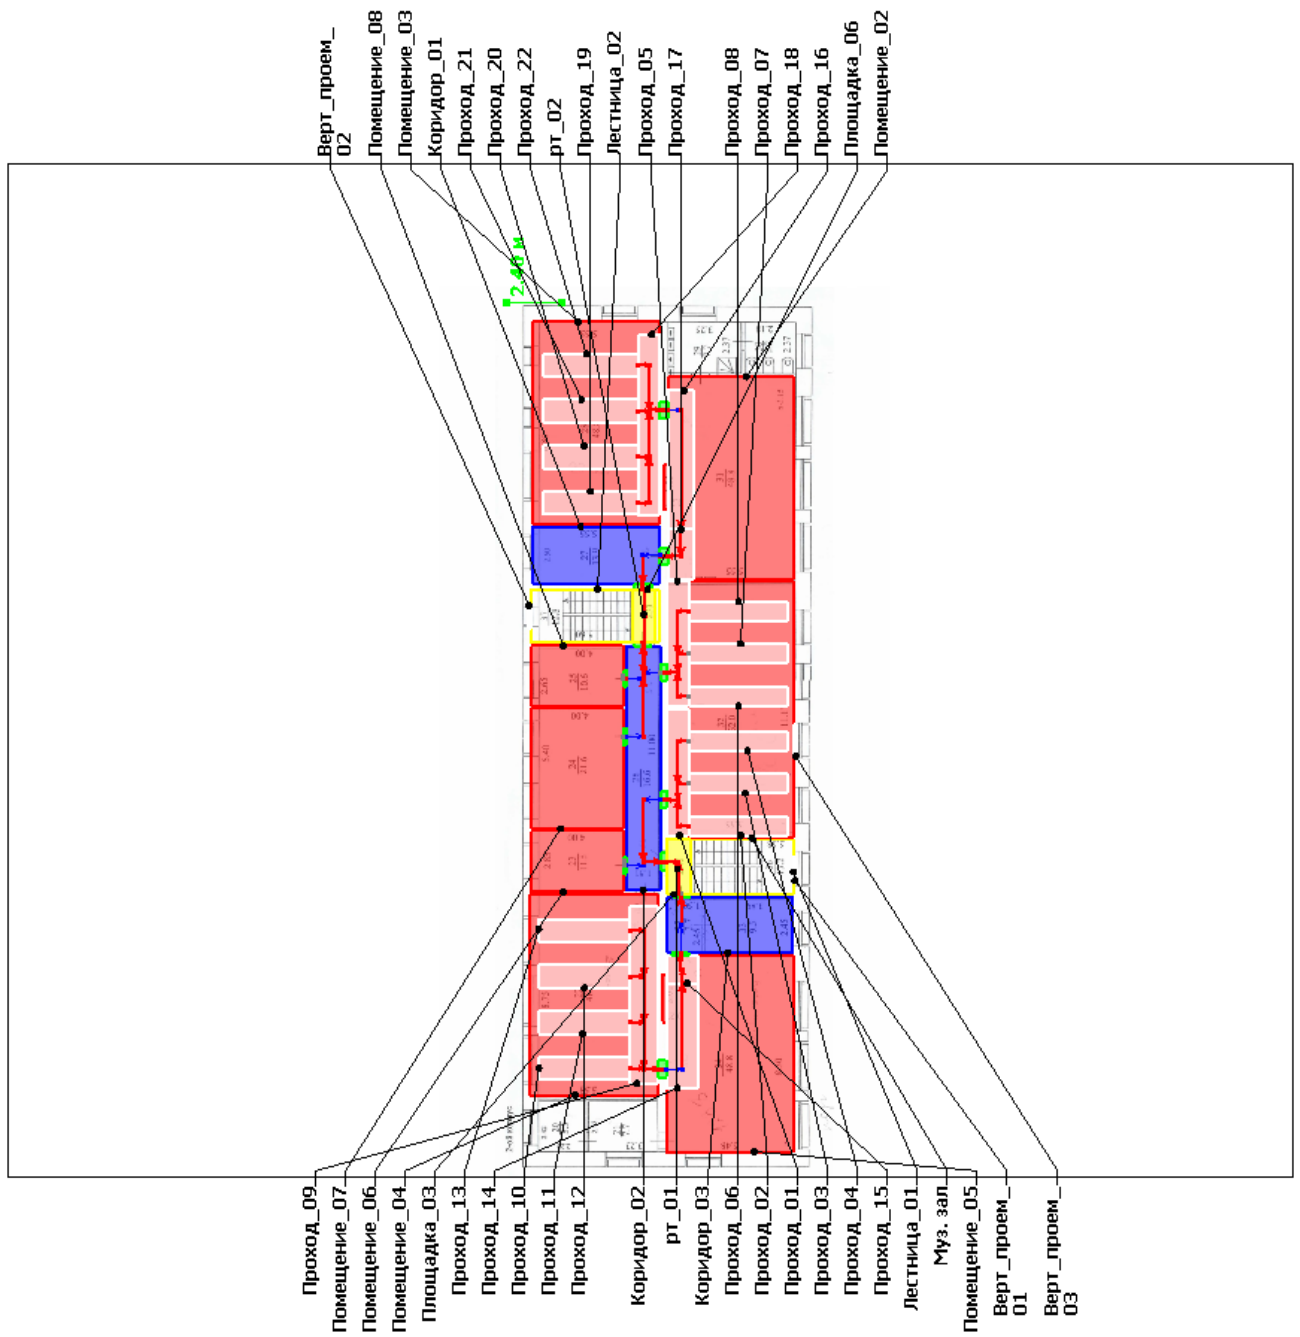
Расчетная схема эвакуации. Этаж 02
